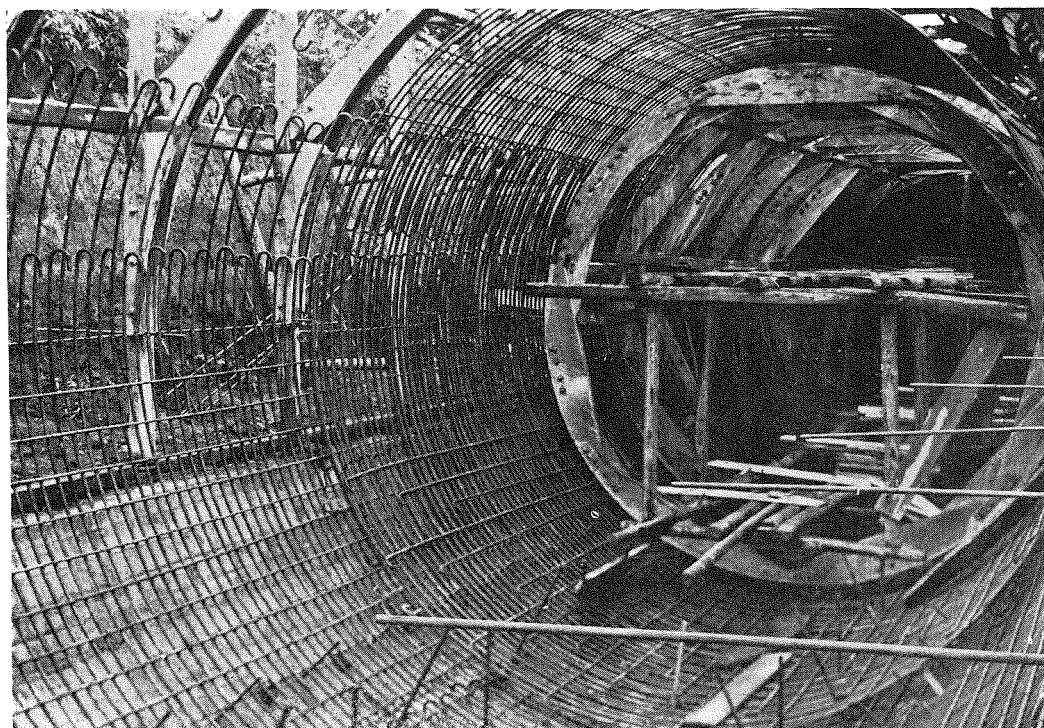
水壓混凝土管内部圓形型枠取付及二重鐵筋配置。
